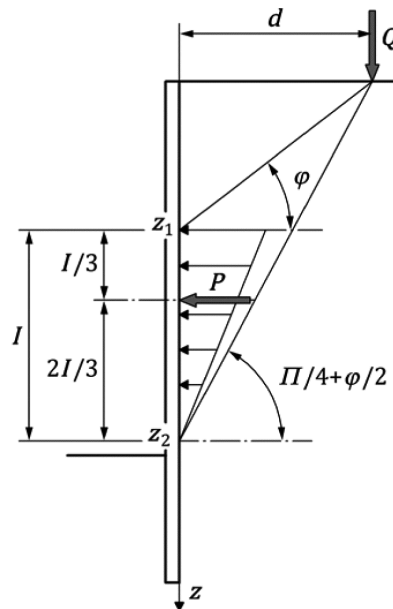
Charge linéique verticale appliquée sur un terrain horizontal
